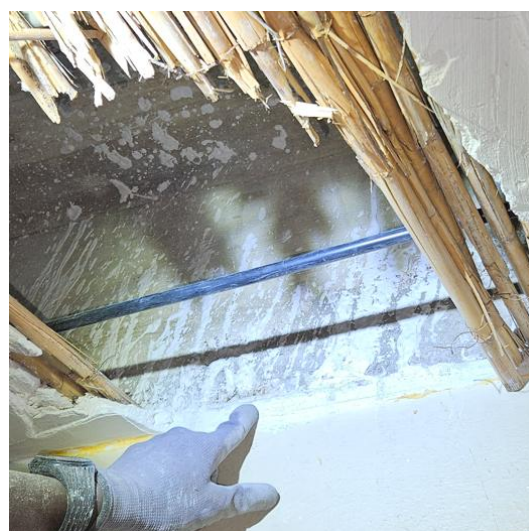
Liaison dalle / mur transversal au droit de la cage d'ascenseur (SS117)
